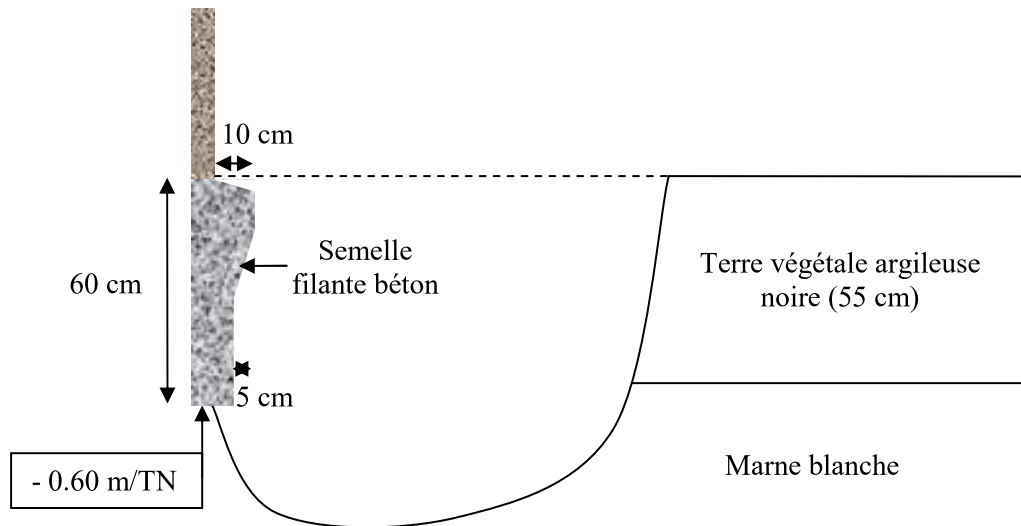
Schéma de la reconnaissance des fondations de l'existant (RF1) (échelle : 1/20).
